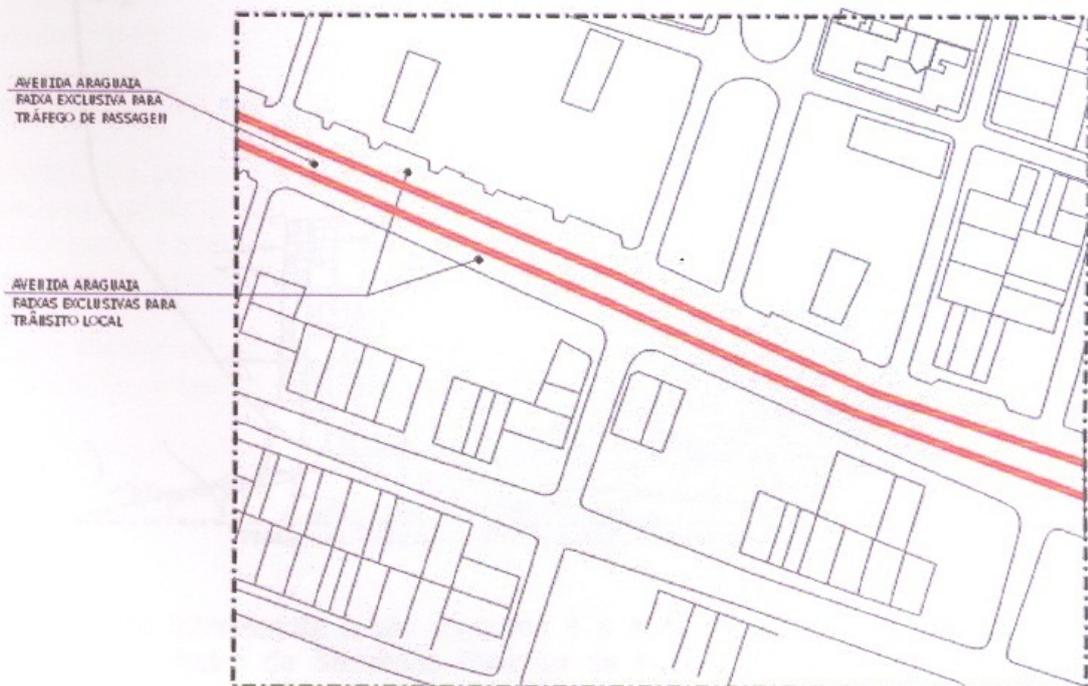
CROQUI AVENIDA ARAGUAIA
